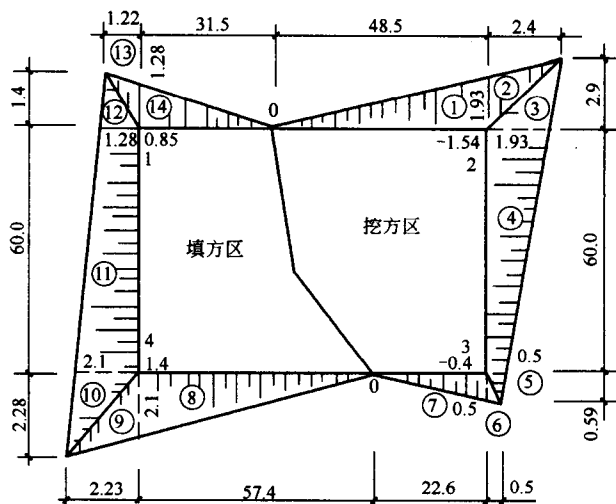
场地边坡平面轮廓尺寸图(尺寸单位:m)
